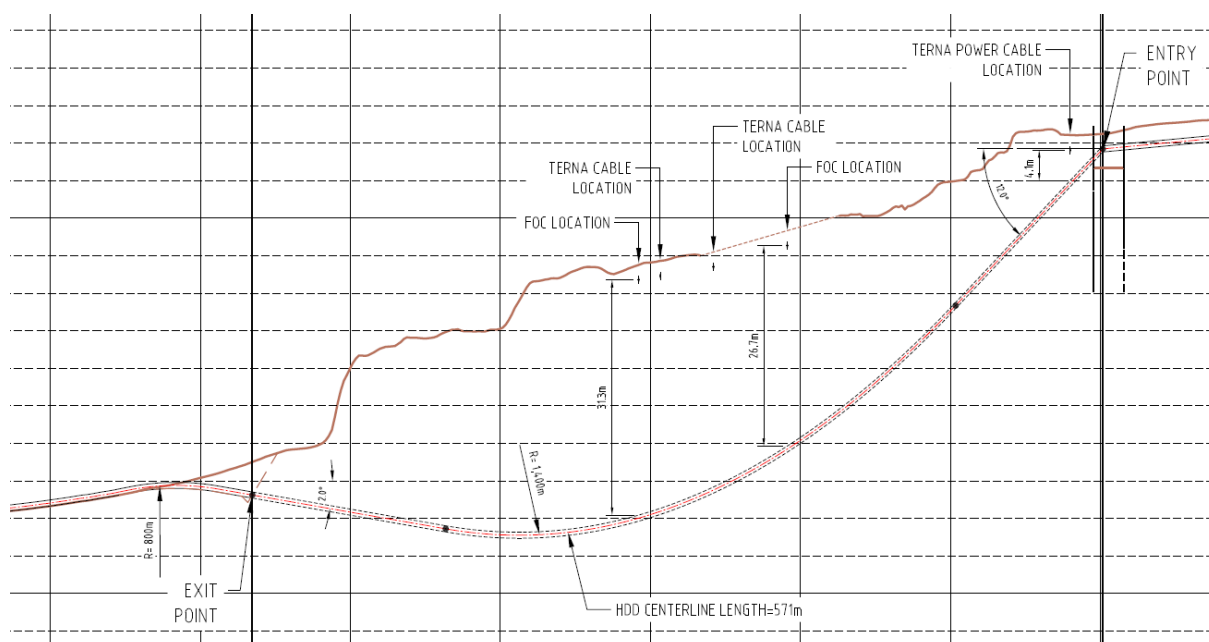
Rappresentazione del Tracciato della TOC e Attraversamenti
